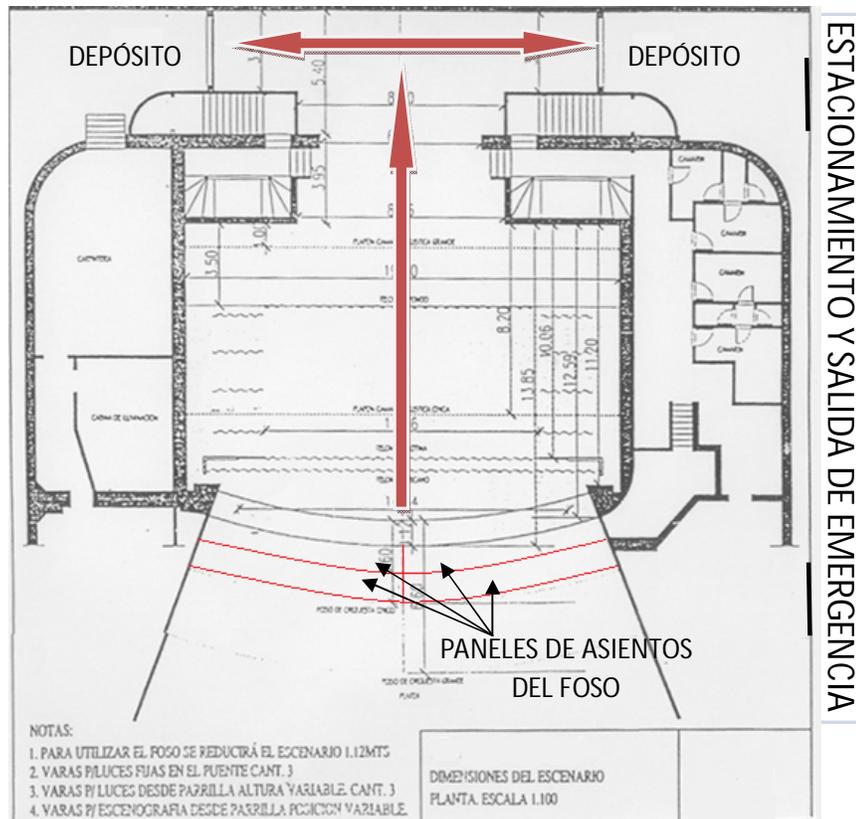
Plano de vista vertical del escenario. Obsérvese el recorrido propuesto de los paneles de asientos del foso a los depósitos ubicados detrás del mismo.
